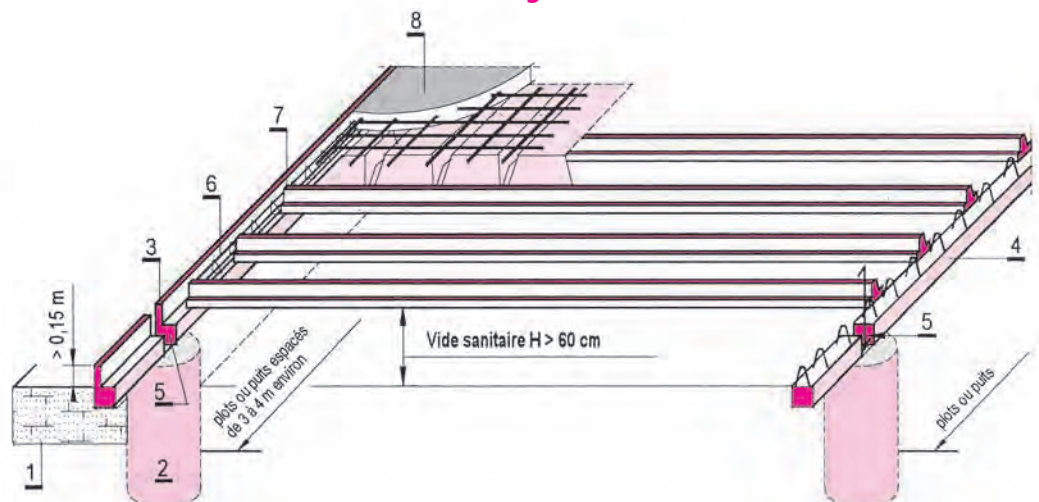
Fondations sur puits ou plots, longrines et plancher à poutrelles sur VS
